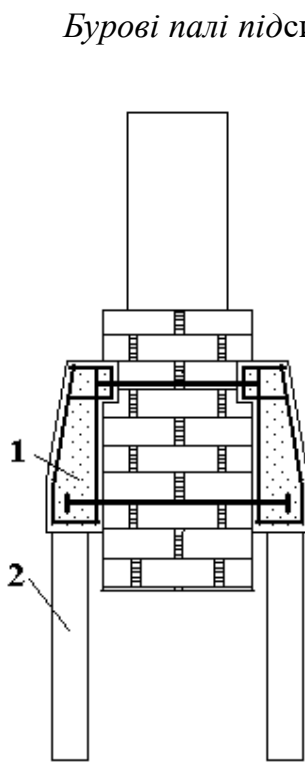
Схеми підсилення фундаментів палями та глибокими стінами:
